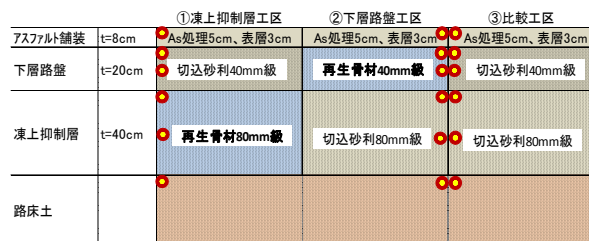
試験施工箇所 (A社構内) 施工時期 H22.10
